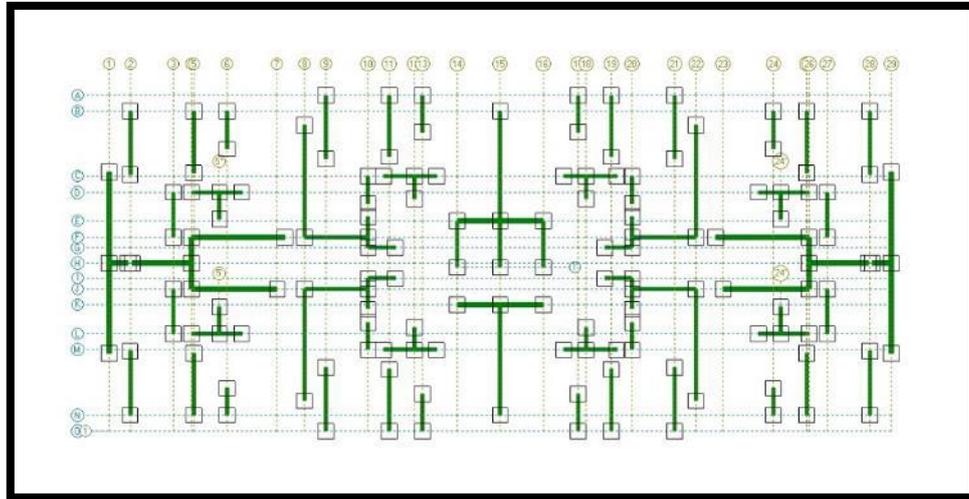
Planta Cimentación Altagracia (Autor, 2018)
